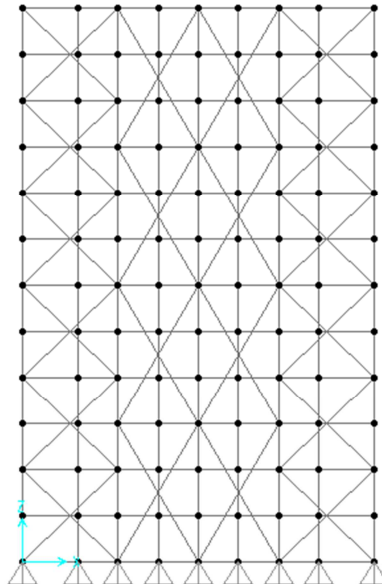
Configuração dos Planos de Contraventamento Vertical Com Elementos de Contraventamento Grandes
